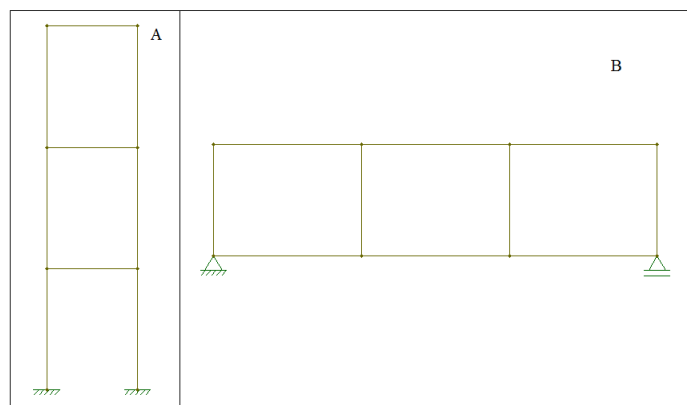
a) Modelo de cálculo de um edifício com vigas e pilares ortogonais entre si; b) Modelo de cálculo do tabuleiro concebido com viga Vierendeel.
